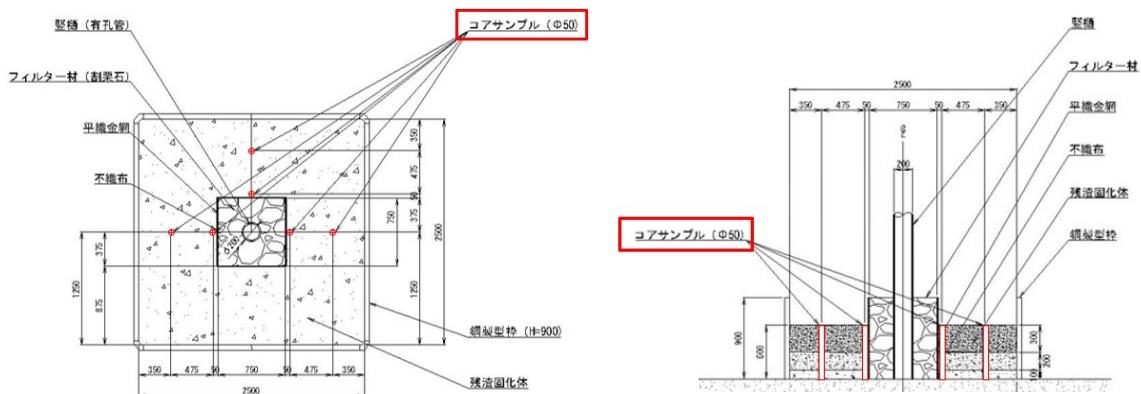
フィルター材との鉛直接合部近辺でのコア採取位置(左:平面図、右:縦断)
